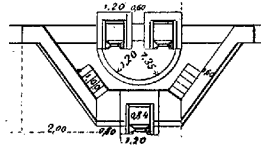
PLAN SUPÉRIEUR DE LA TOUR DE PRISE D'EAU.
